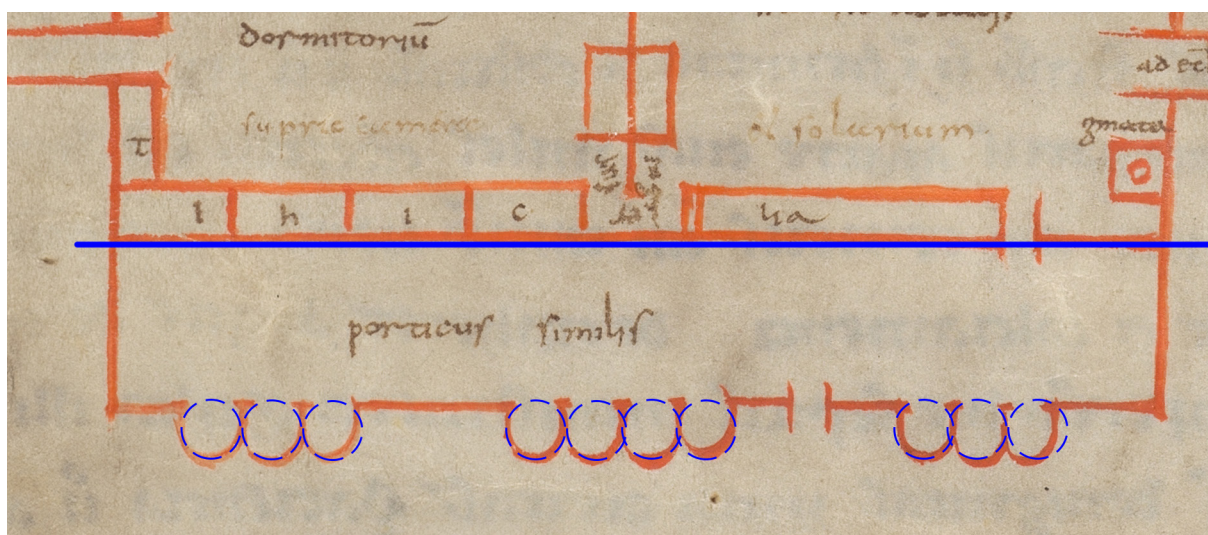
Abtspalast – Westarkaden mit konstruierten gleichen Kreisen
